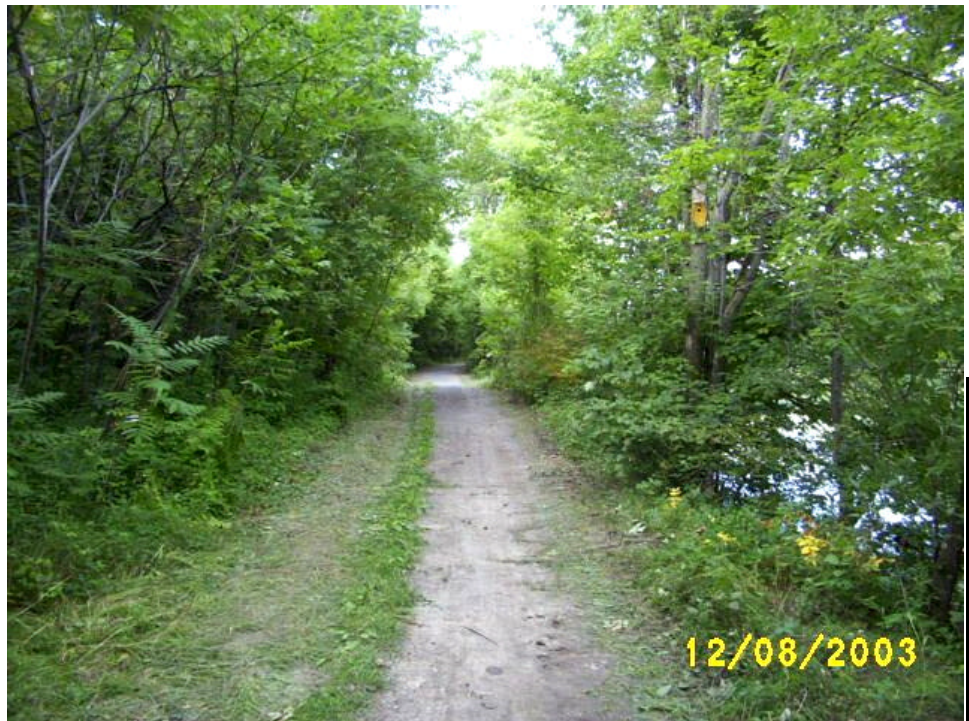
État du sentier Robert suite aux travaux à la démobilité de la machinerie
